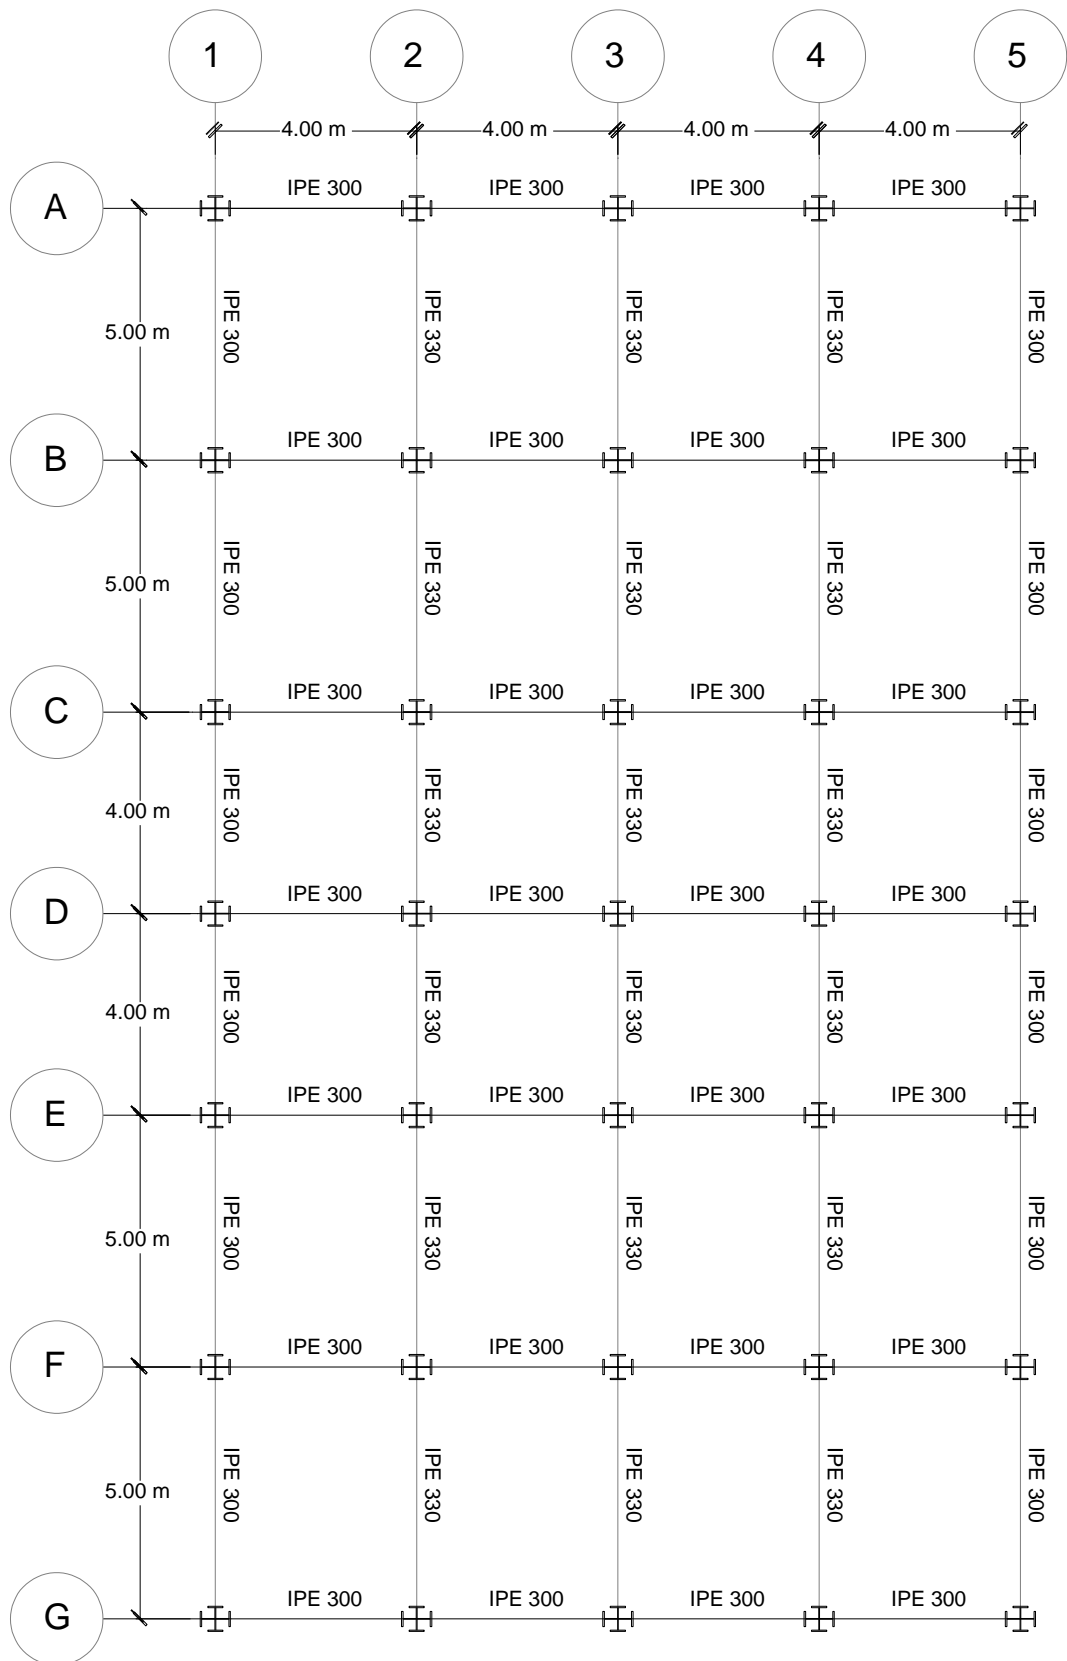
Secciones utilizadas vista en planta piso 4-5.
